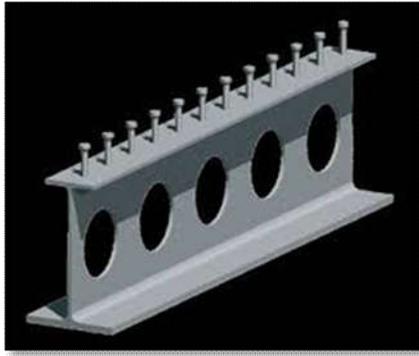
Poutre alvéolaire. Source : ArcelorMittal Europe
